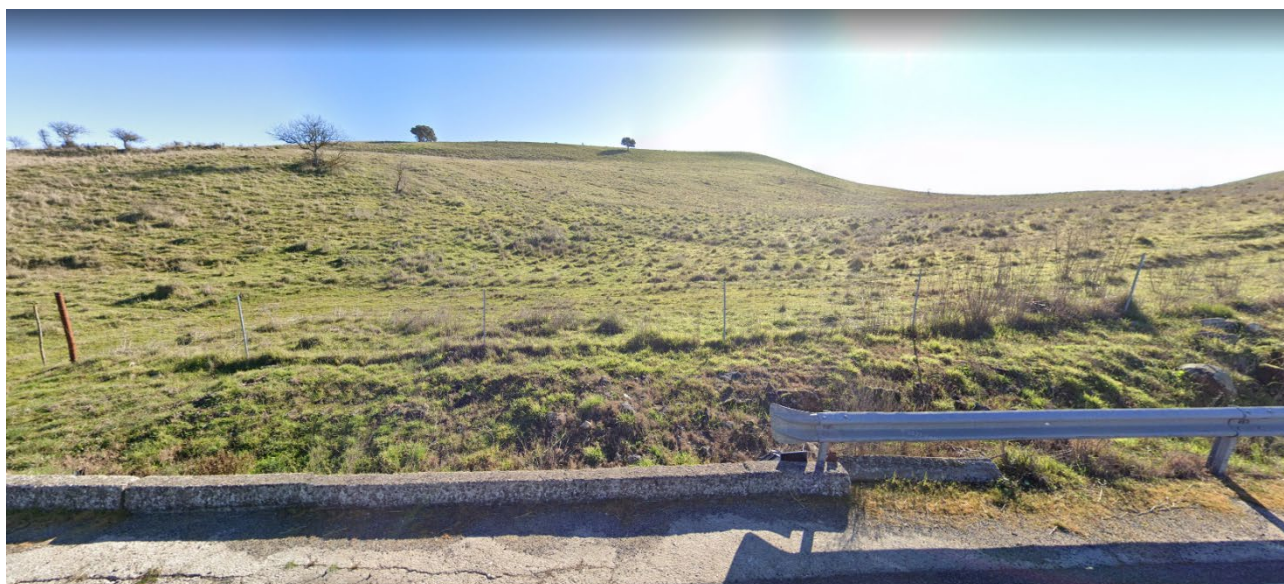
Vista dalla 128 bis verso S-E (Area cantiere 1 - S7)
